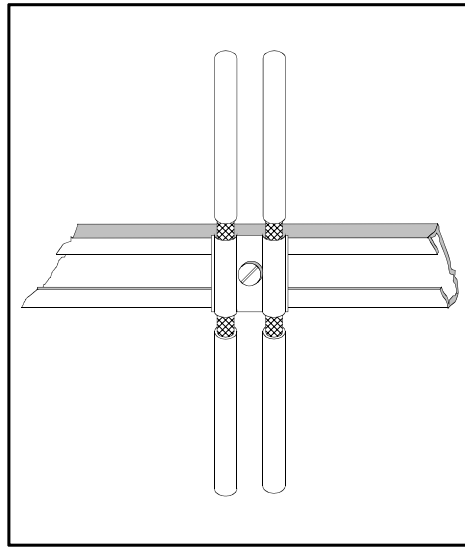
Abrazadera y contrapieza metálicas sobre barra de cables
